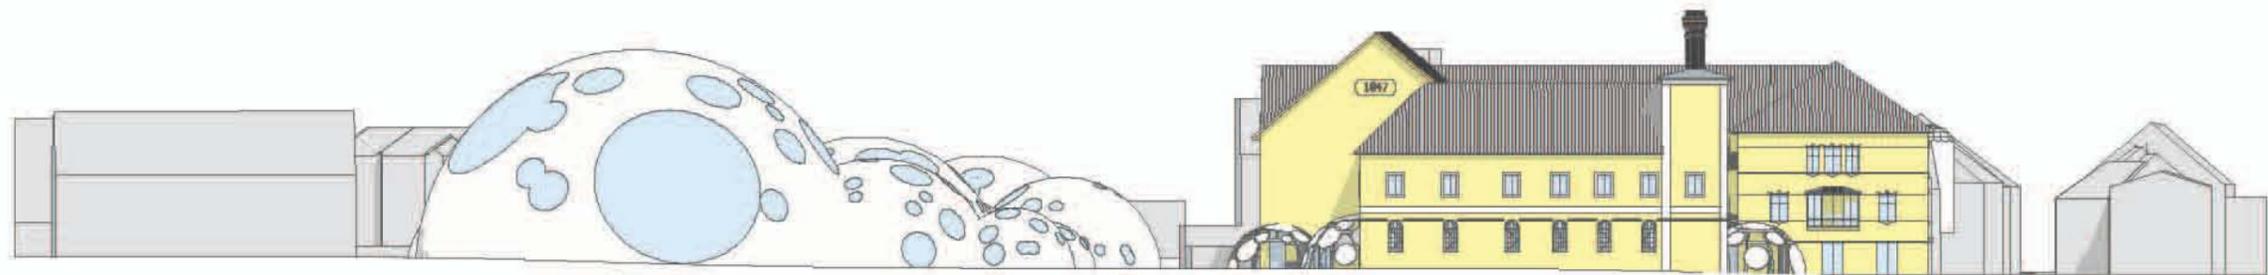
Süd Ansicht Hallenbad - Restaurant (ehem. Sudhaus)
